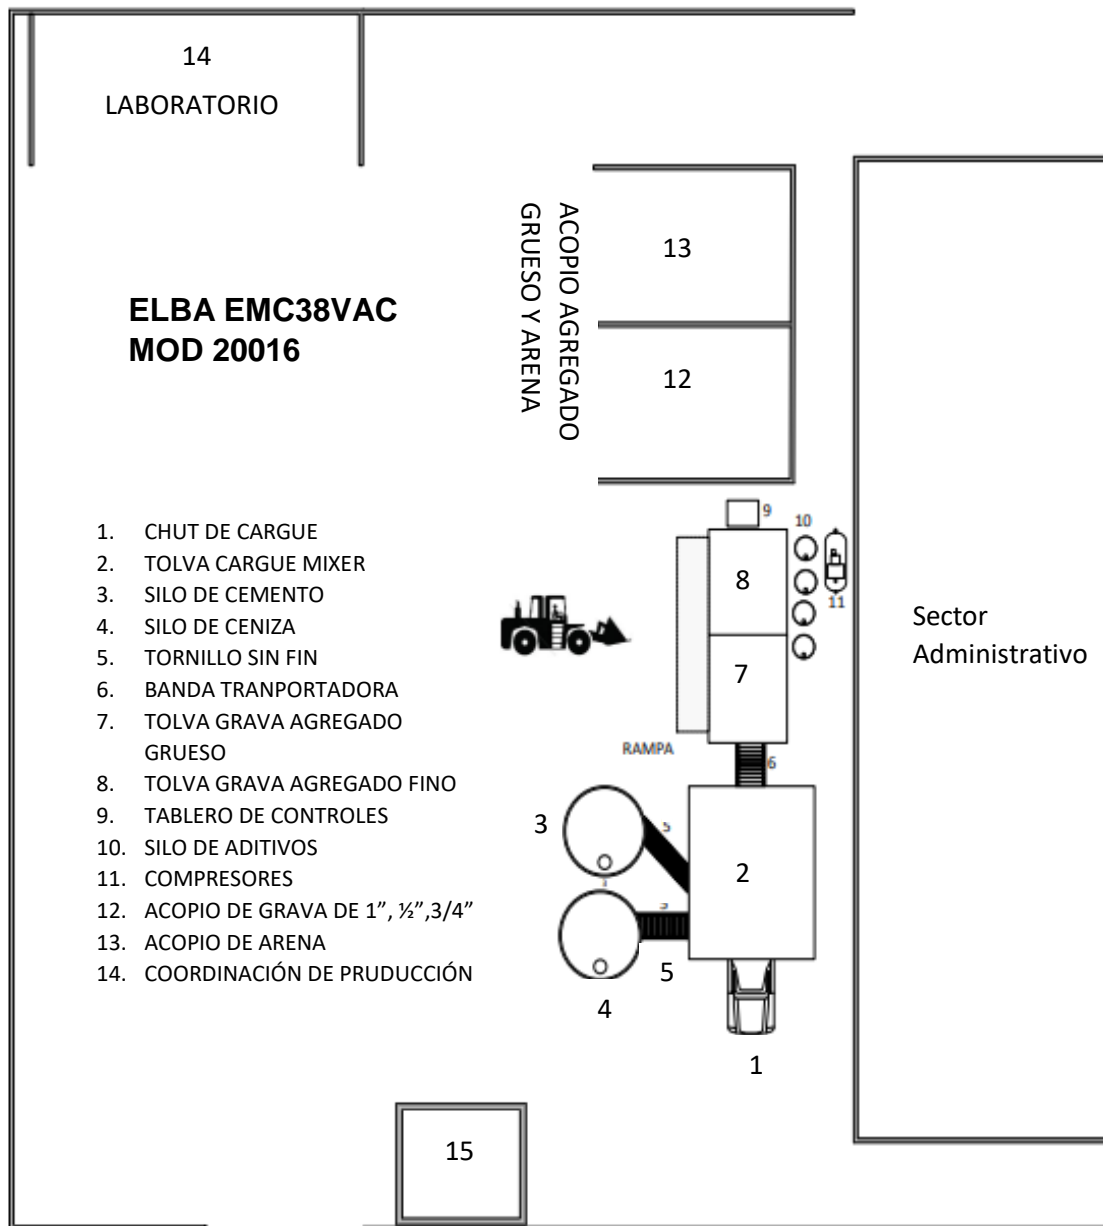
Di seño de la Planta FUENTE: PROPIA
